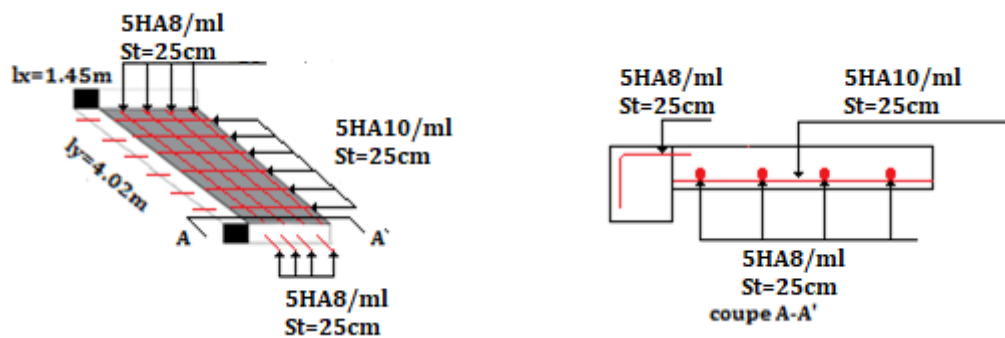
Schéma de ferrailage de dalle pleine (DP4).
